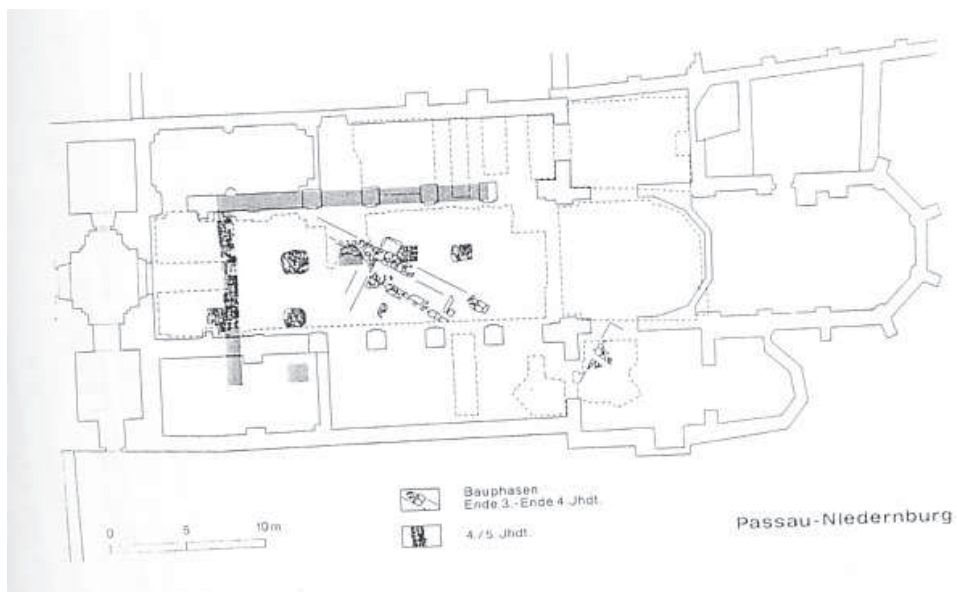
Kreuzkirche, Grundriss mit Einzeichnung des spätrömischen Horreums durch Rainer Christlein.
